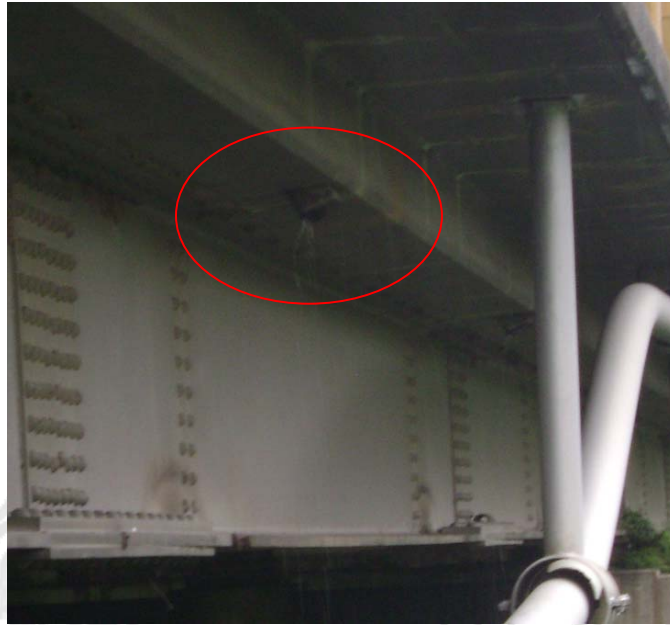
Parte inferior de la rejilla expuesta debajo de los drenajes.
